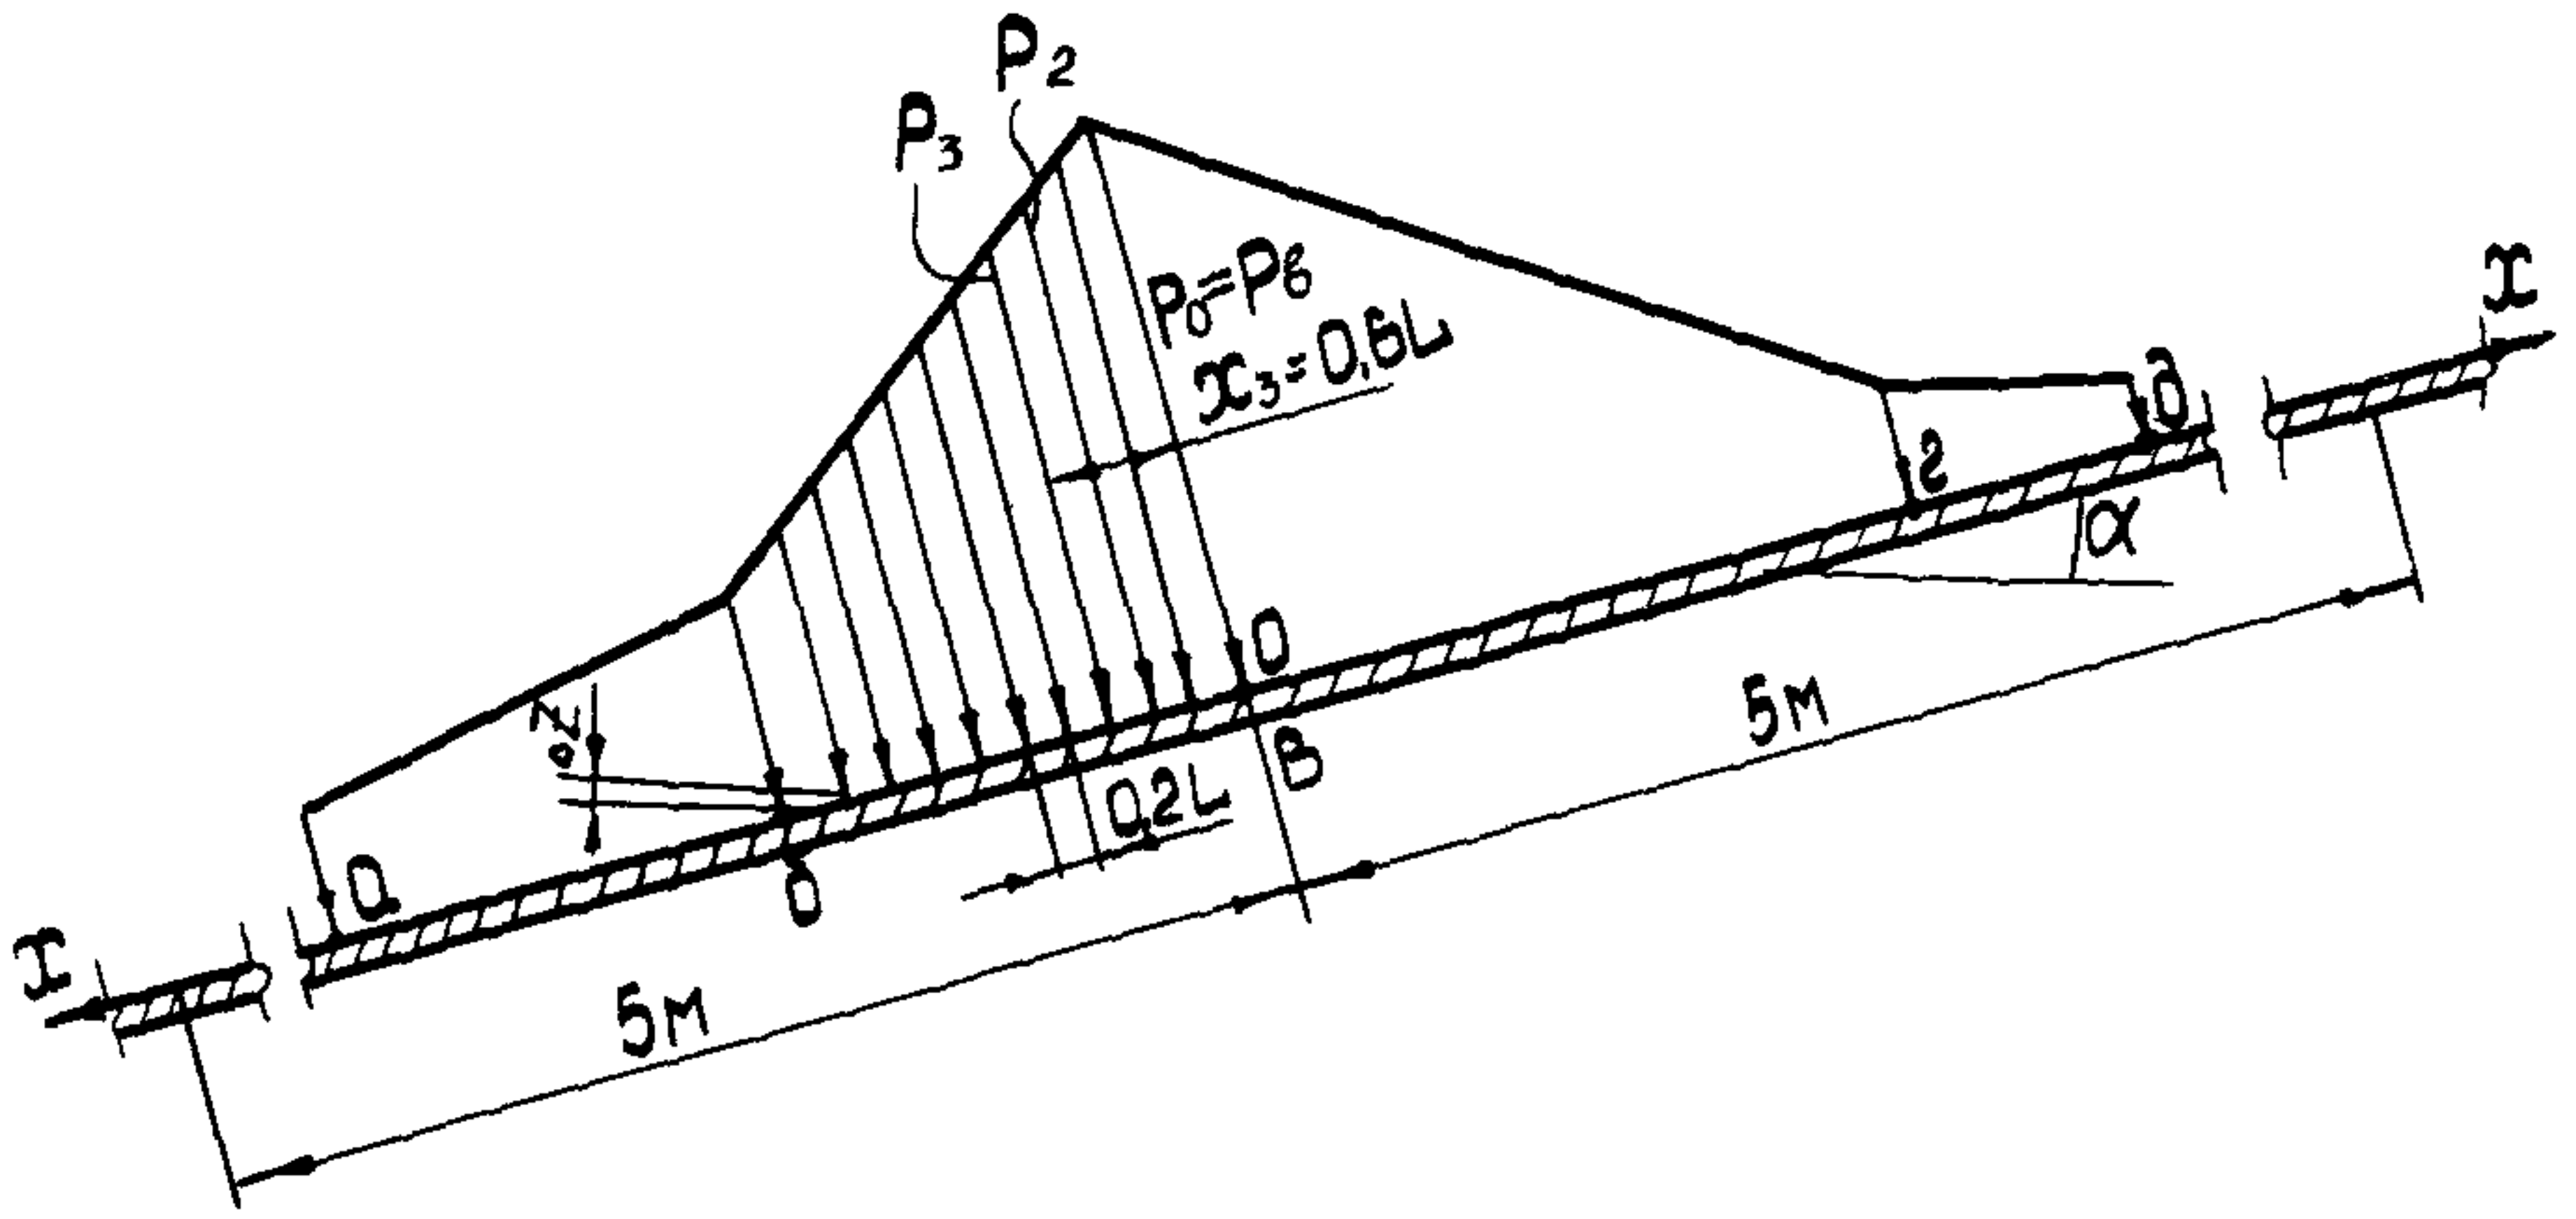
Схема сил к расчету на прочность монолитного железобетонного покрытия при волновой нагрузке.
